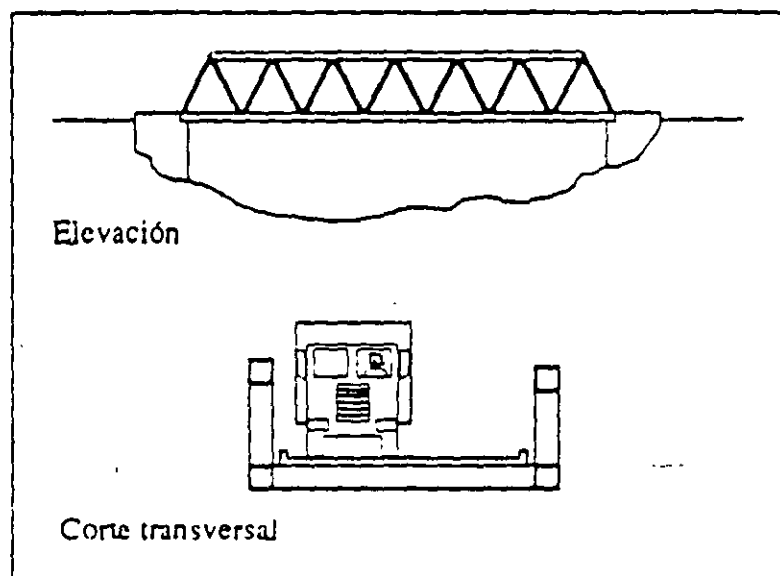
Sección transversal, tipo 42, Armadura a Paso A Través
